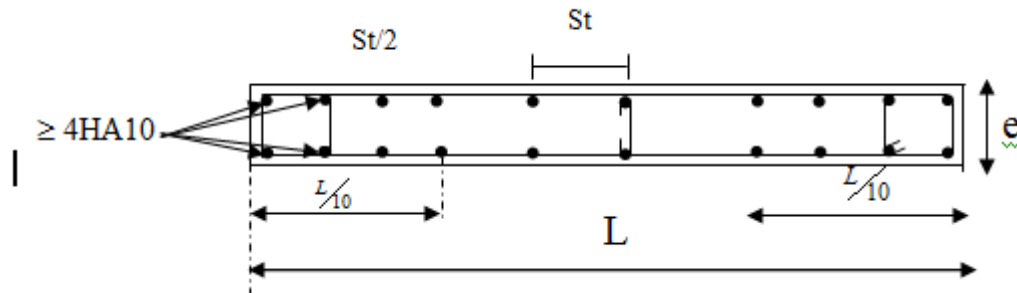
Disposition des armatures verticales dans les voiles.
